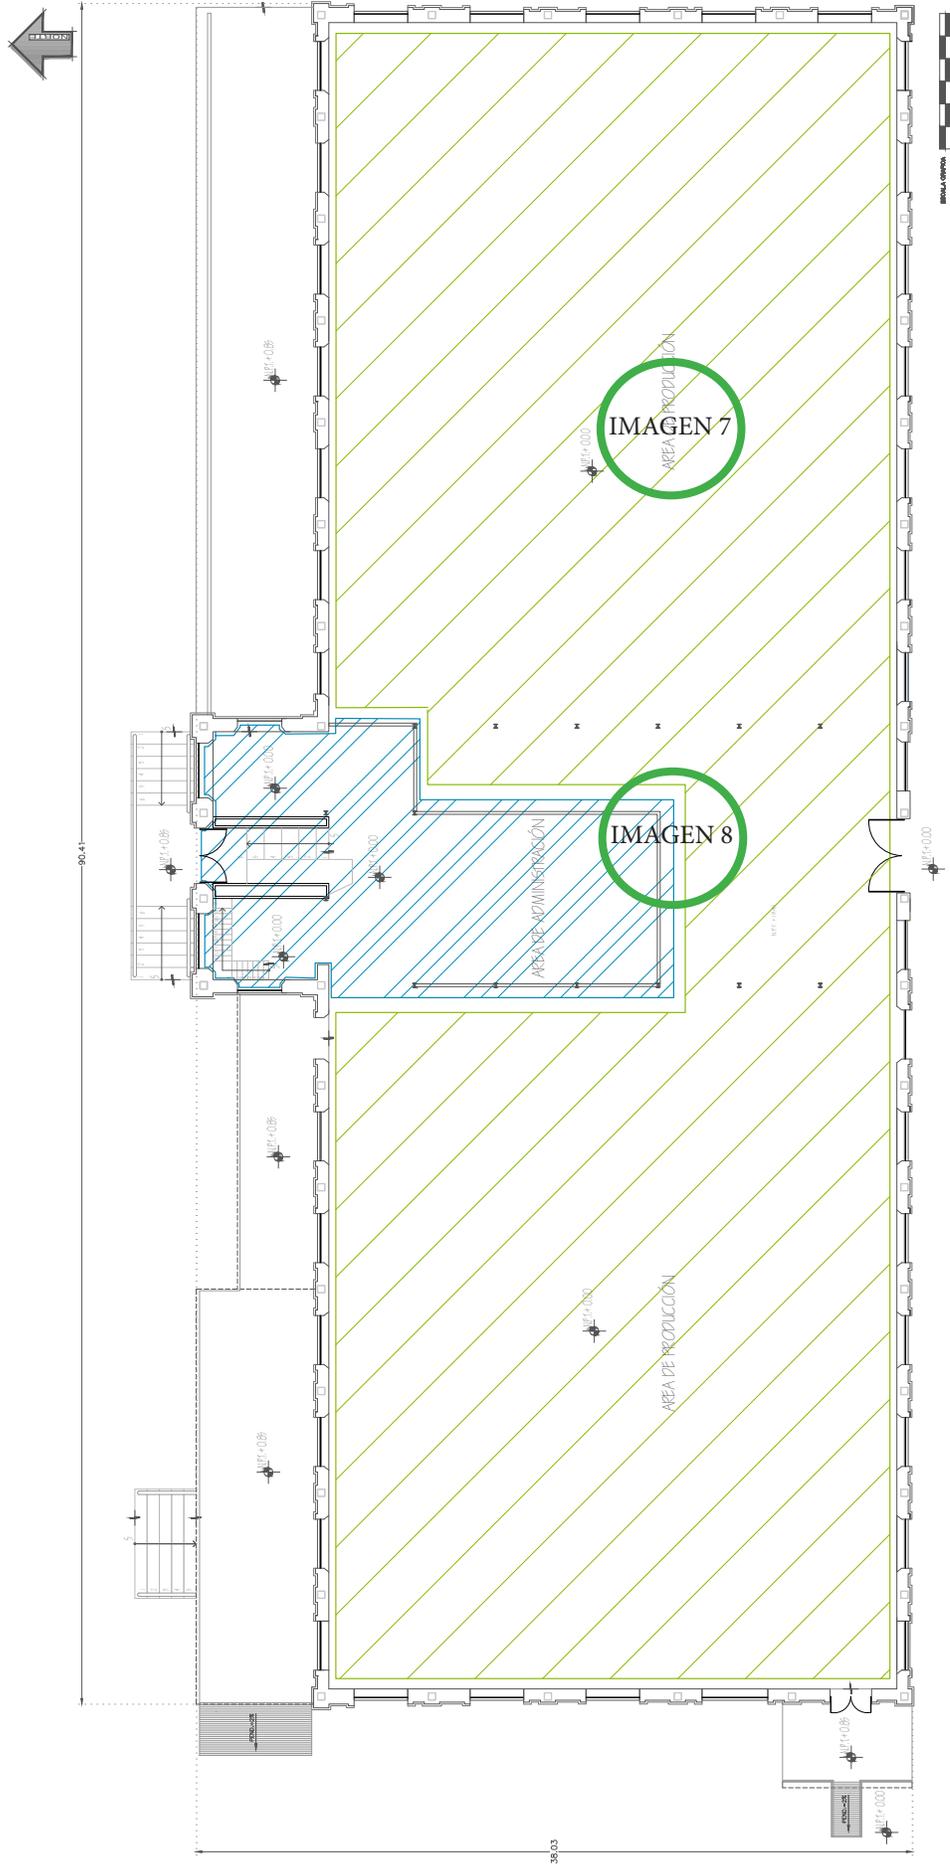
Imagen II. Planta arquitectónica edificio-B central con la ubicación de las imágenes que corresponden al proceso productivo
